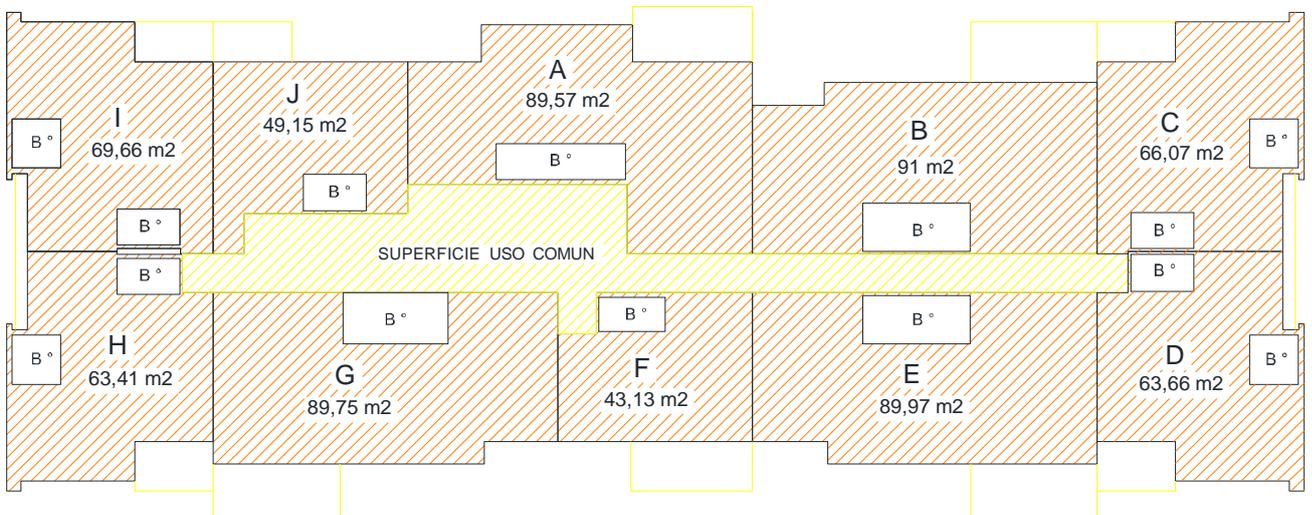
PLANTA 4°, 5°, 6° y 7 PISO
